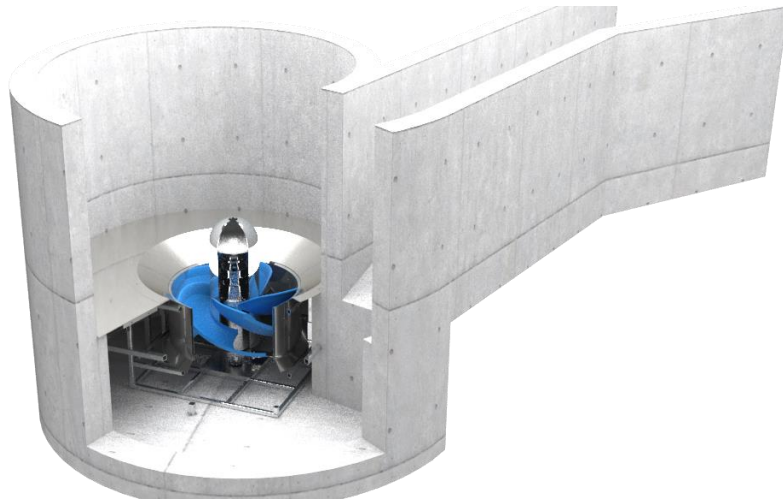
Estructura de la turbina entregada por el fabricante. Fuente: Fabricante de turbinas tipo
